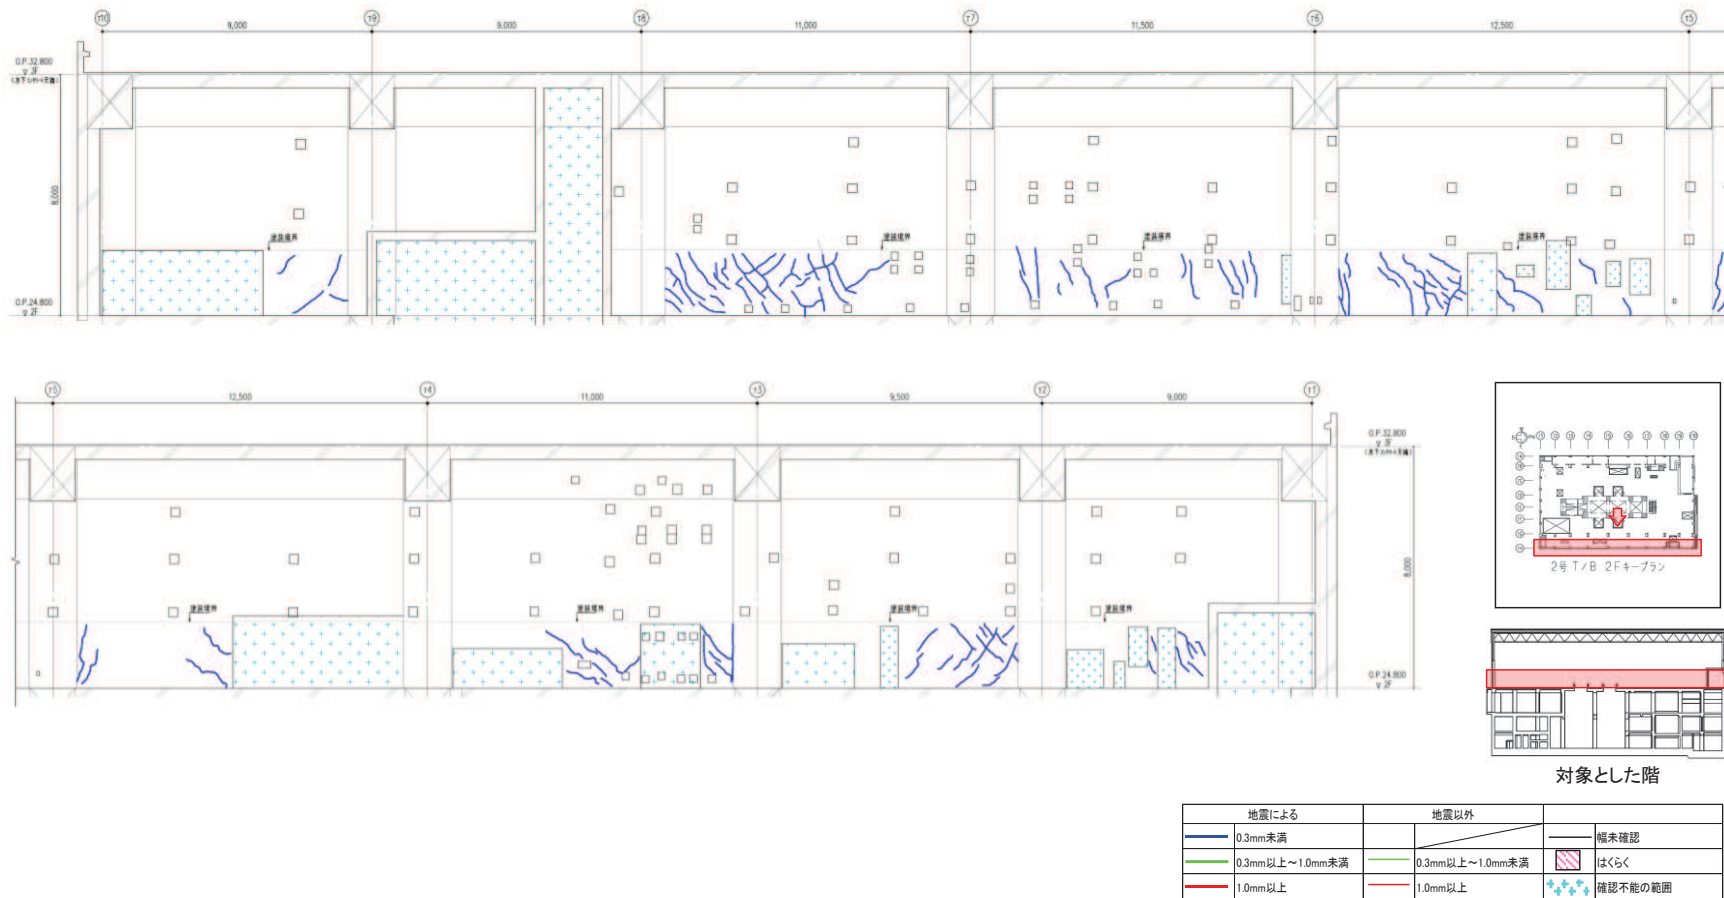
タービン建屋のひび割れ分布 耐震壁 (52) 2階 TH 通り
